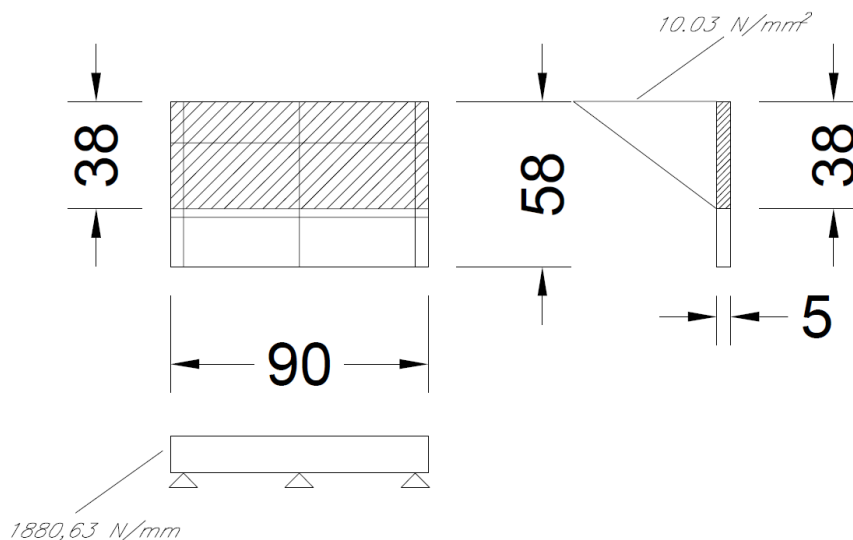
Schematizzazione della piastra come una trave su più appoggi
